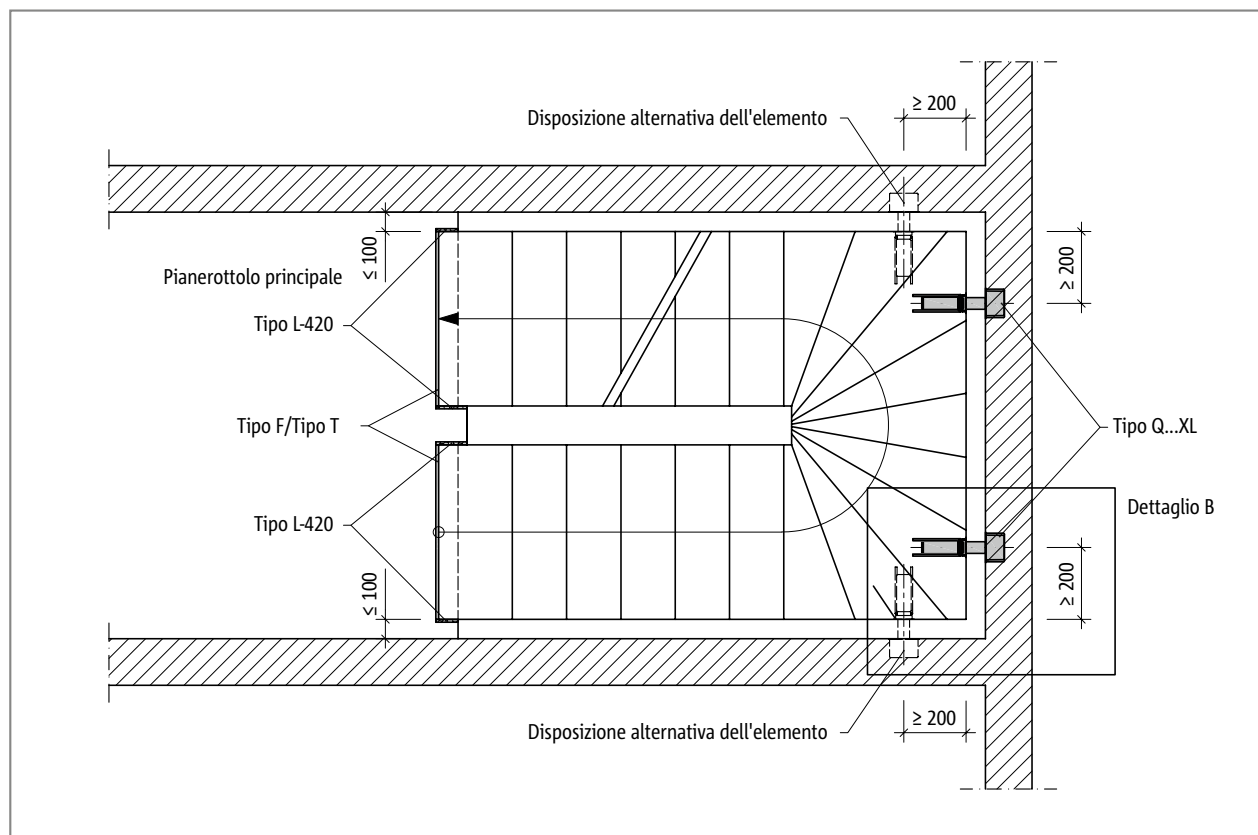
Schöck Tronsole® tipo Q...-XL, disposizione dell'elemento nella pianta con una larghezza del giunto di massimo 100 mm
